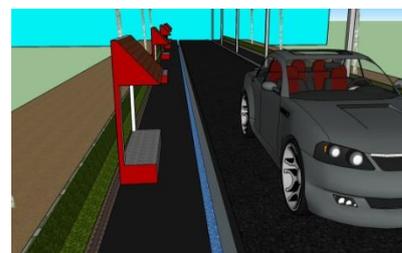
Penyelesaian Site Plan jalan dusun Sarwodadi kidul
